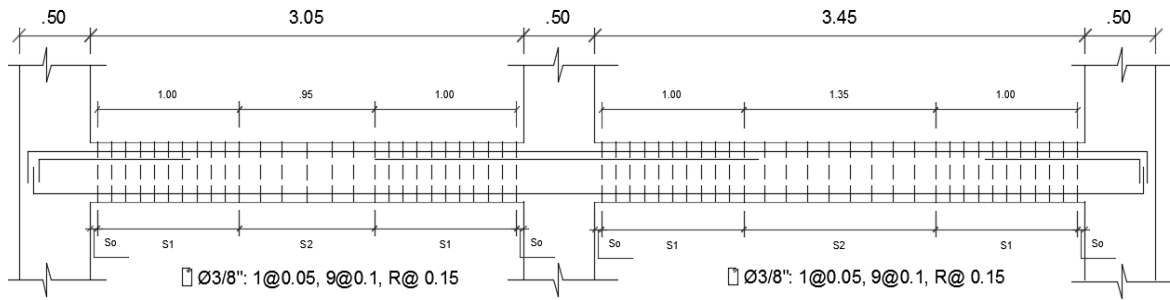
Distribución de acero transversal en Viga. Elaboración propia.
